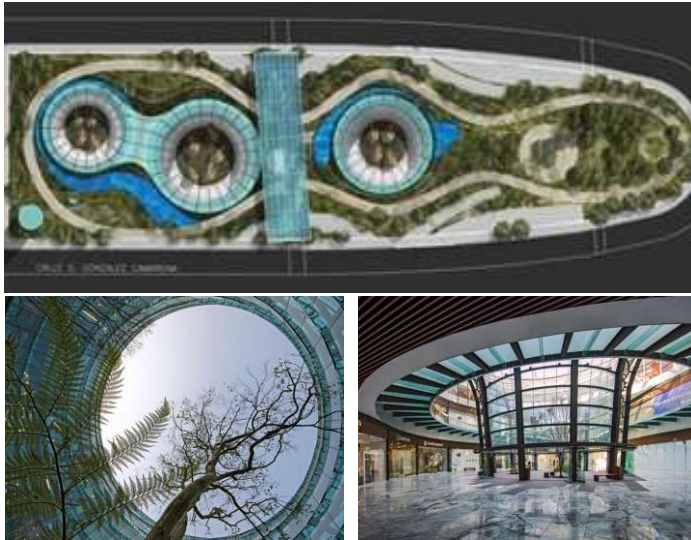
Planimetría de Planimetría de Garden Plaza, Santa Fe. Imágenes del proyecto.
